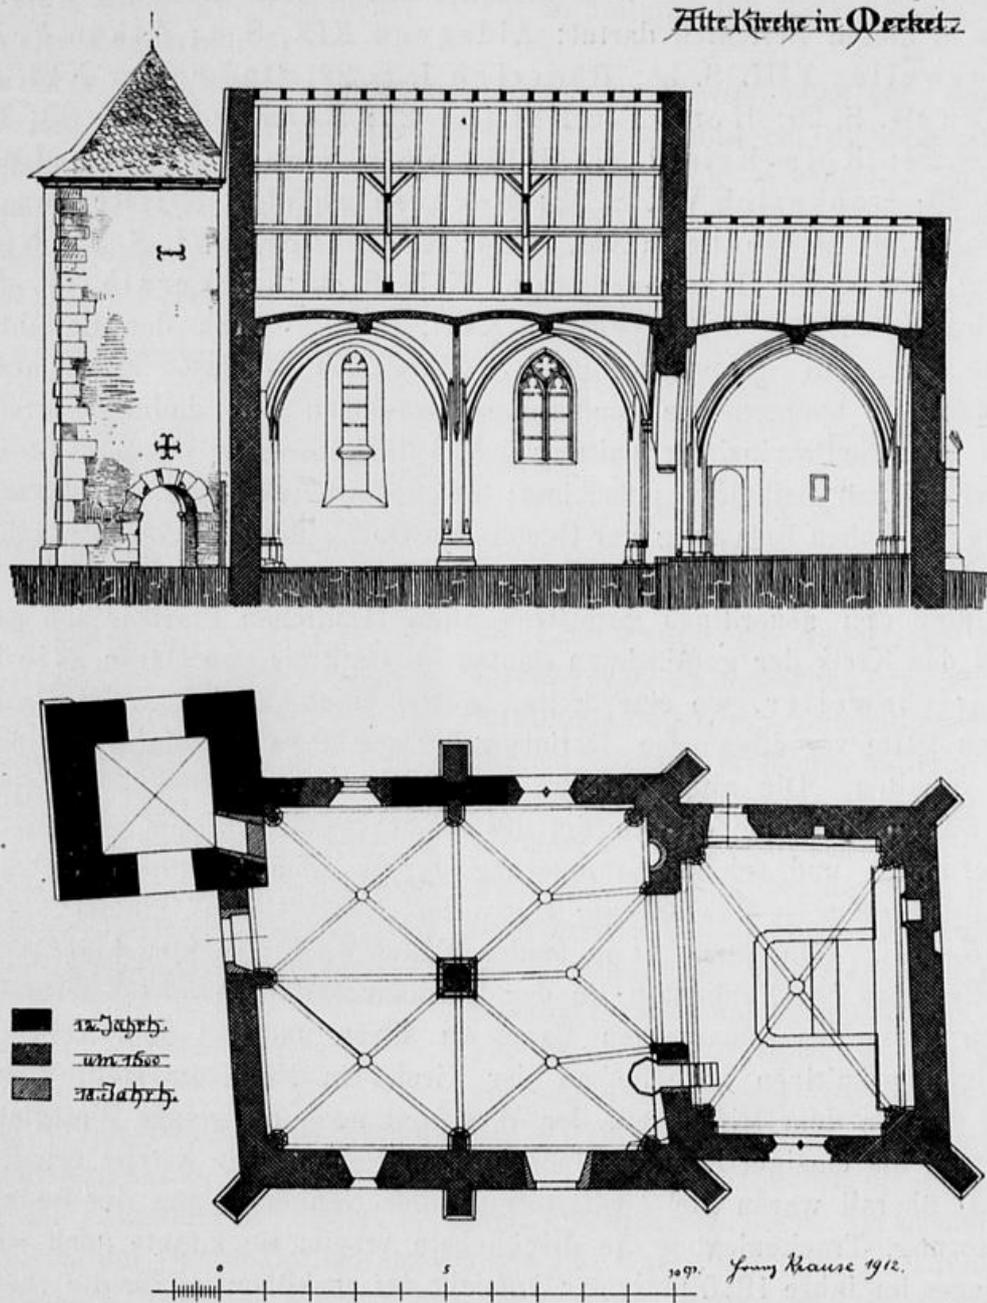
Meckel. Grundriss und Längenschnitt der alten Pfarrkirche.
